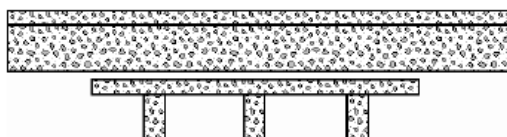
Puente con vigas longitudinales de hormigón armado (Alvarado C., 2004)
